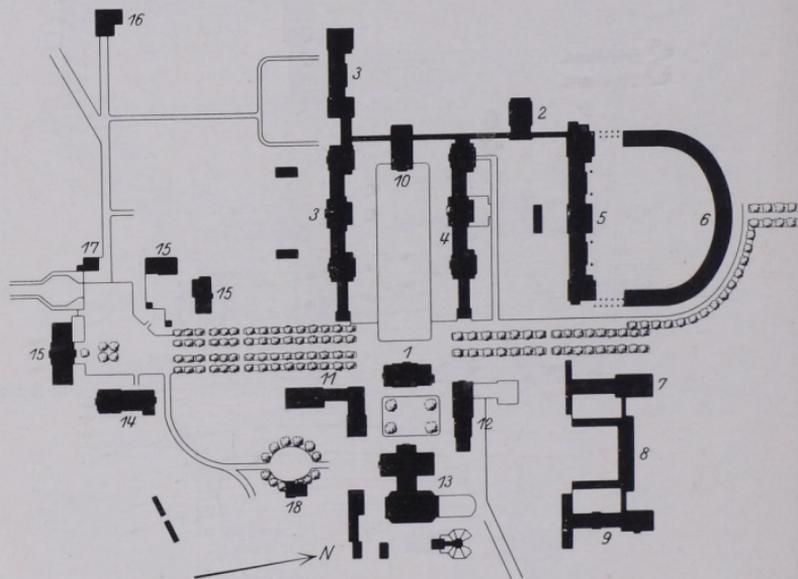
Lageplan des Waldhauses Charlottenburg.
